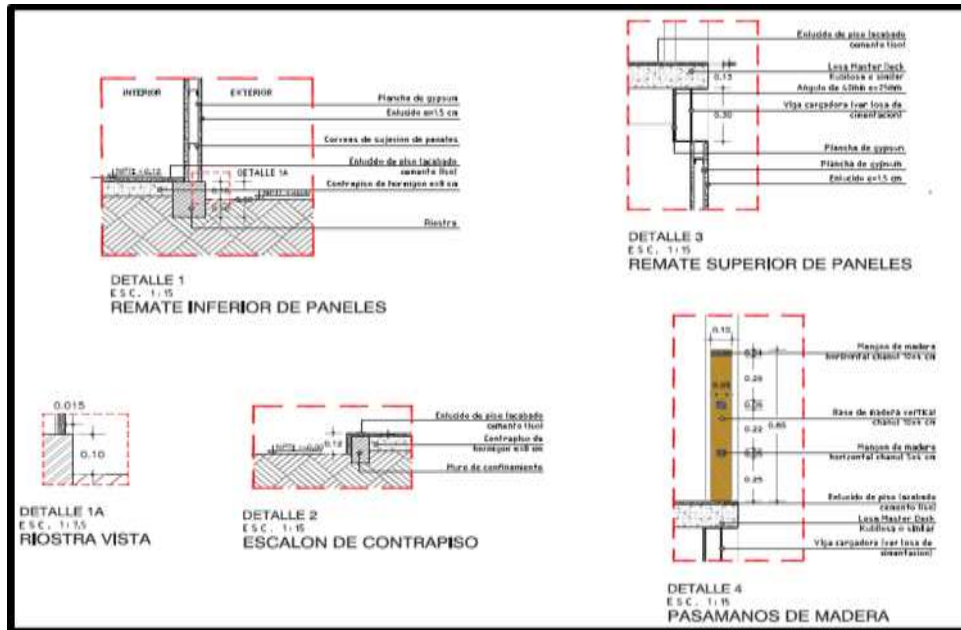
Prototipo 1, Detalles arquitectónicos
